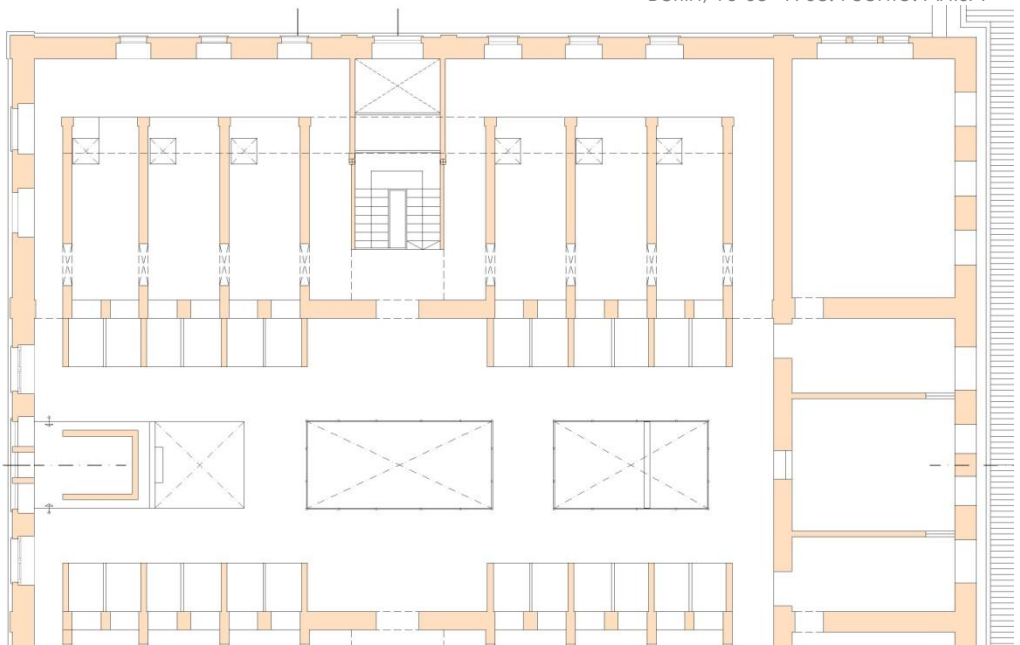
Planta de distribución realmente ejecutada de la Planta Segunda.
